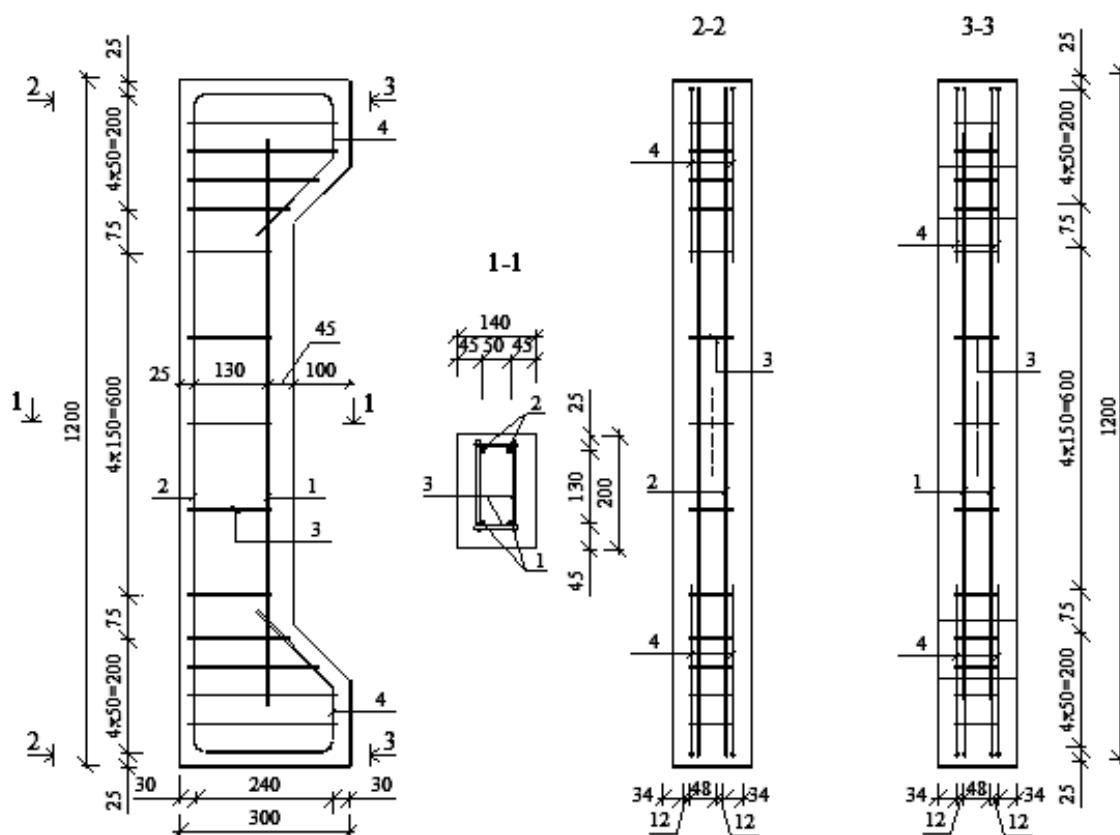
Досліджувана конструкція (опалубочне креслення і армування)
